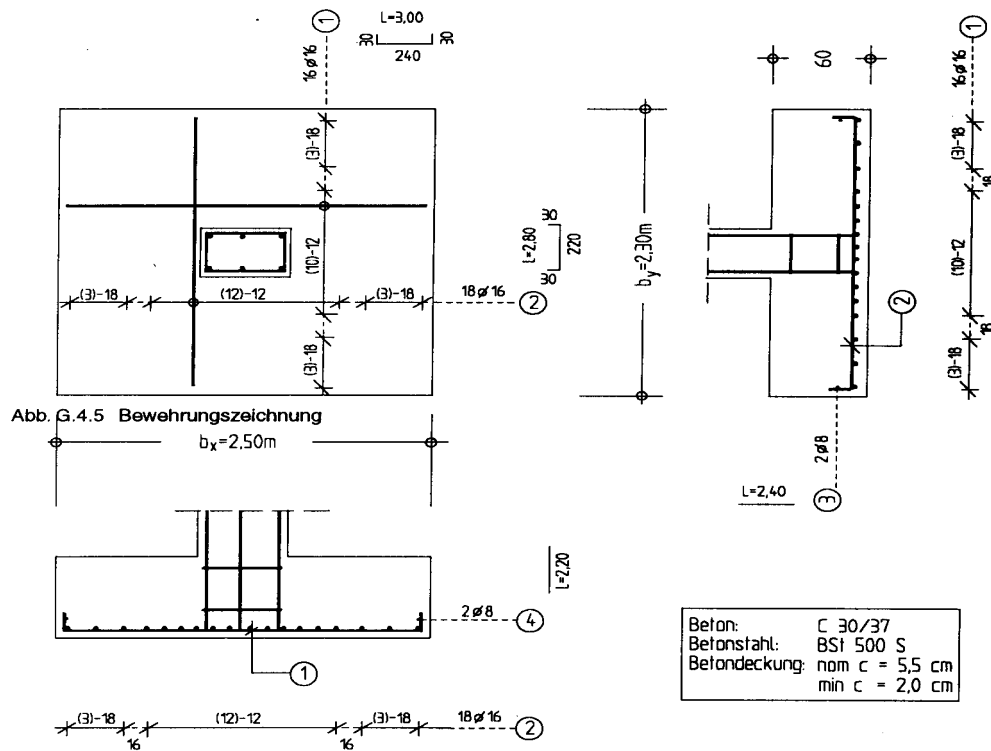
Beispiel für Bewehrungsplan eines Einzelfundamentes ohne Durchstanzbewehrung
